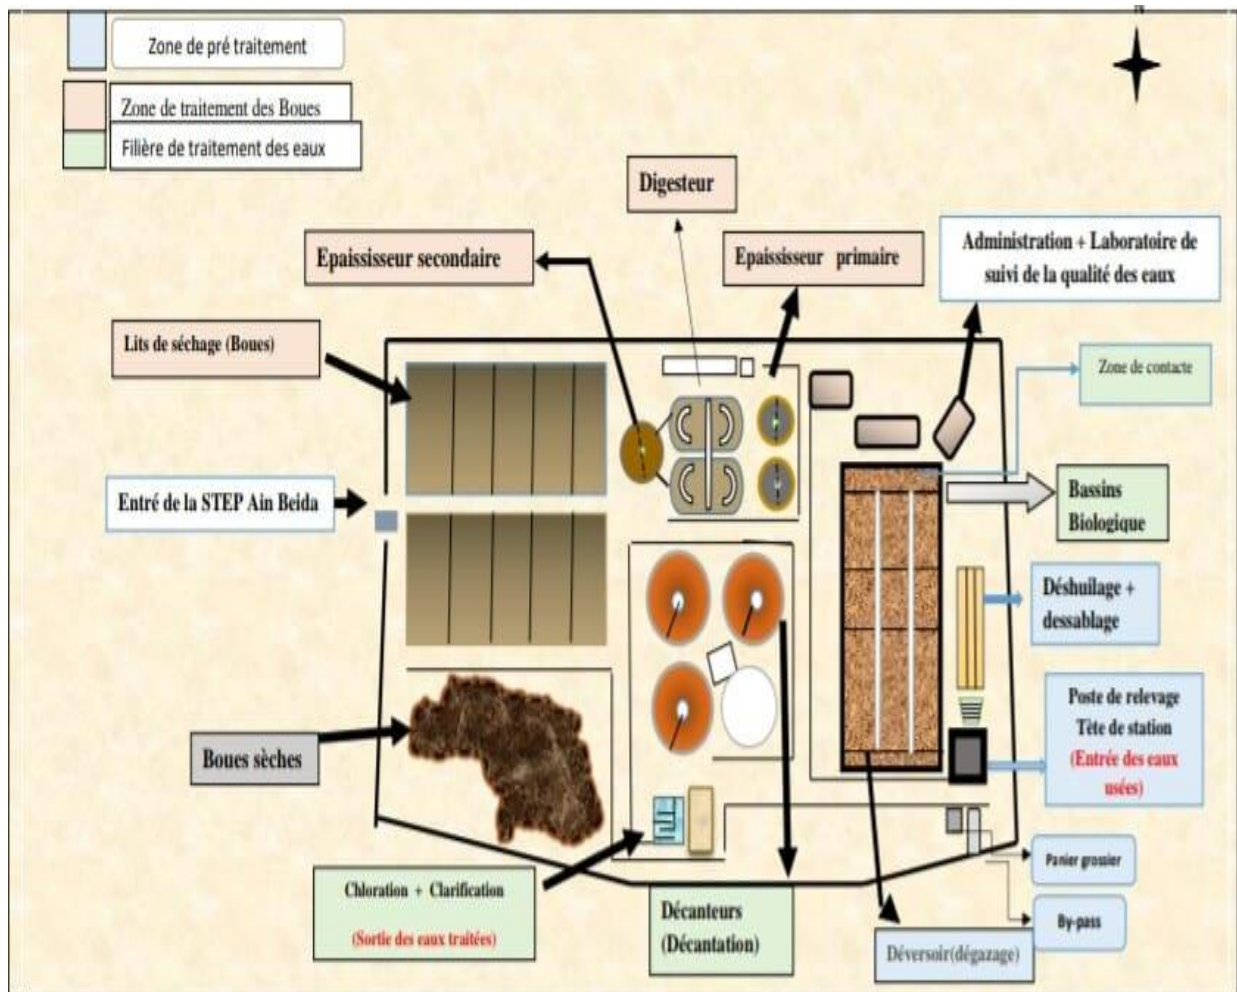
Plan générale des ouvrages de la STEP (F.T STEP Ain El-Beida)
